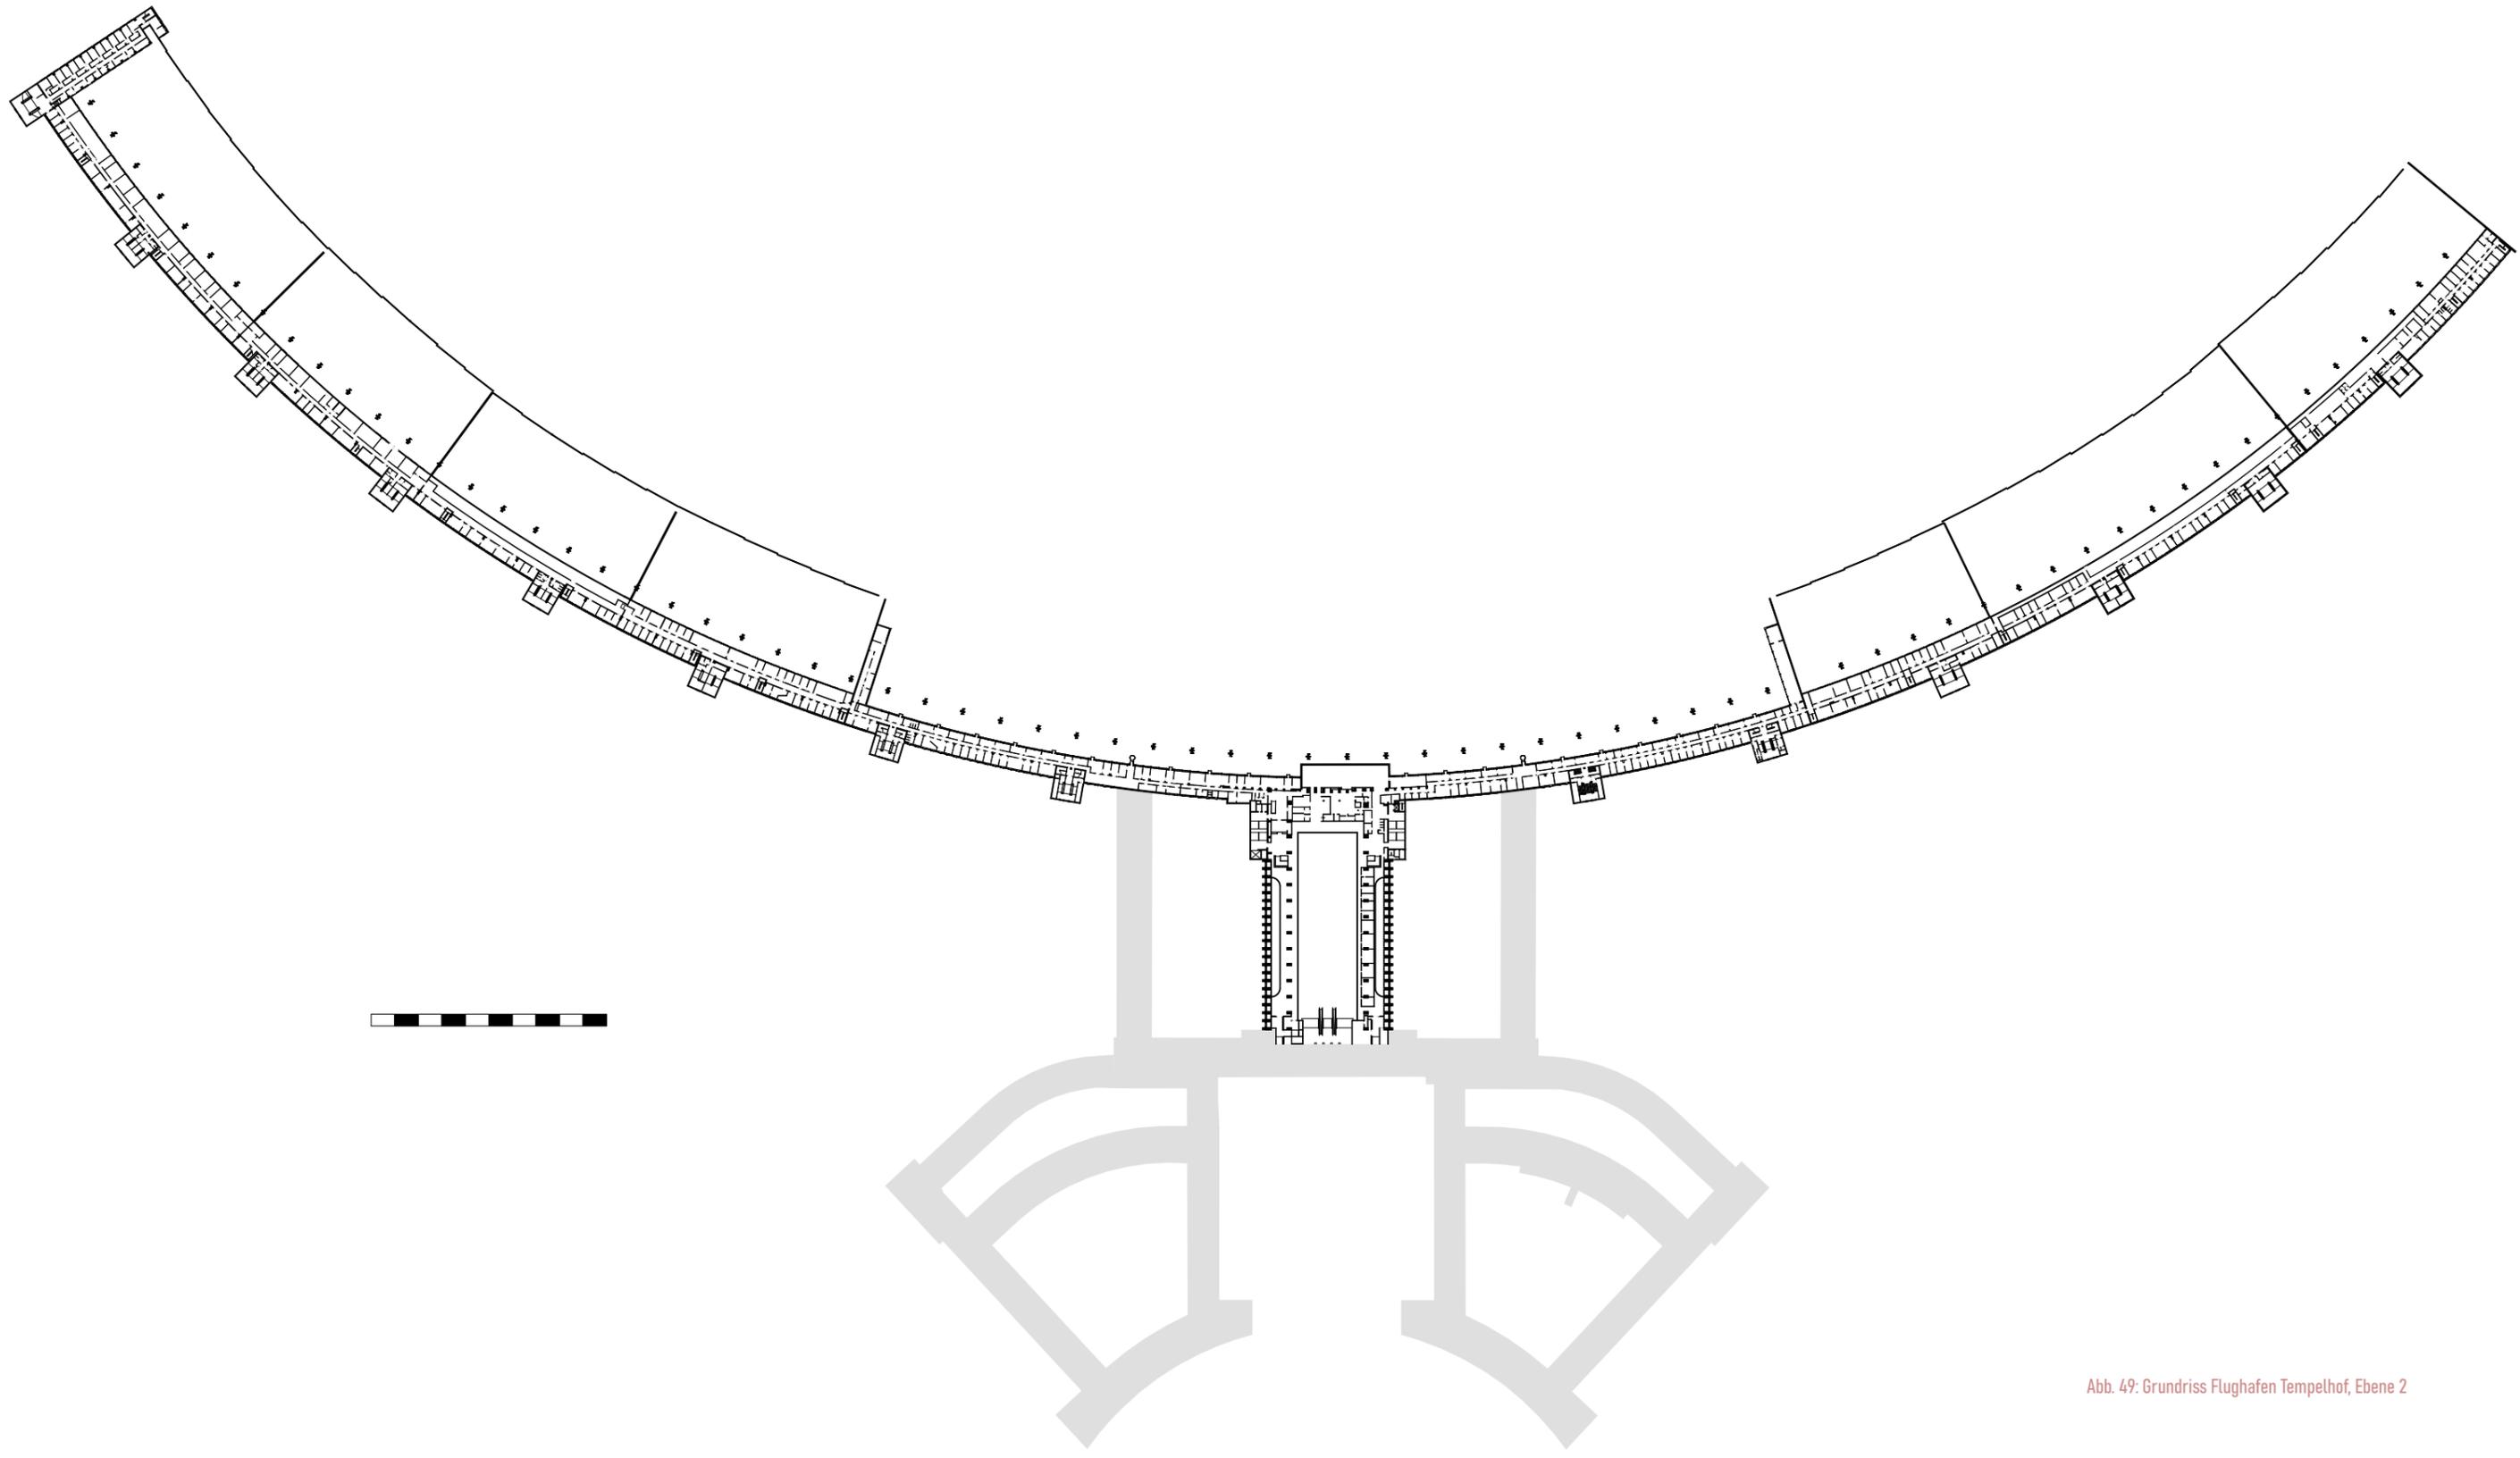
Grundriss Flughafen Tempelhof, Ebene 2
